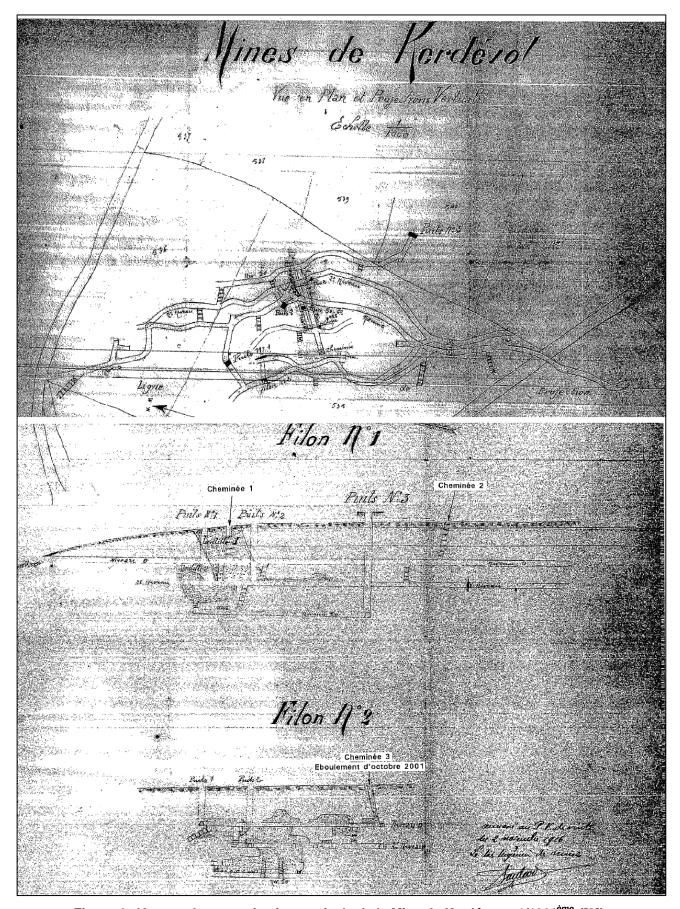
Vue en plan et projection verticale de la Mine de Kerdévot – 1/1000ème ([3])
